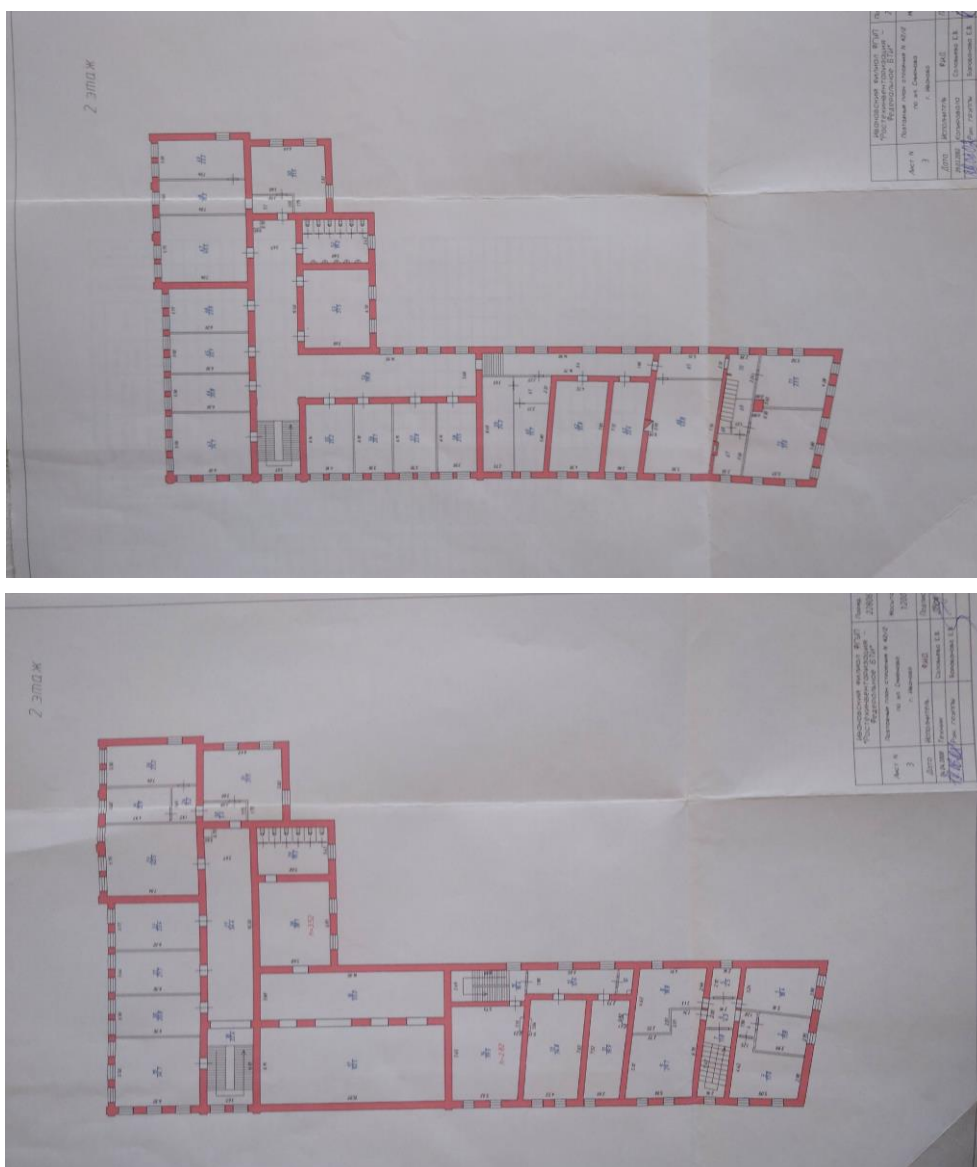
, 52. Планы 2 этажа здания № 42/2 по ул. Смирнова на 2002 г. и 2008 г.
